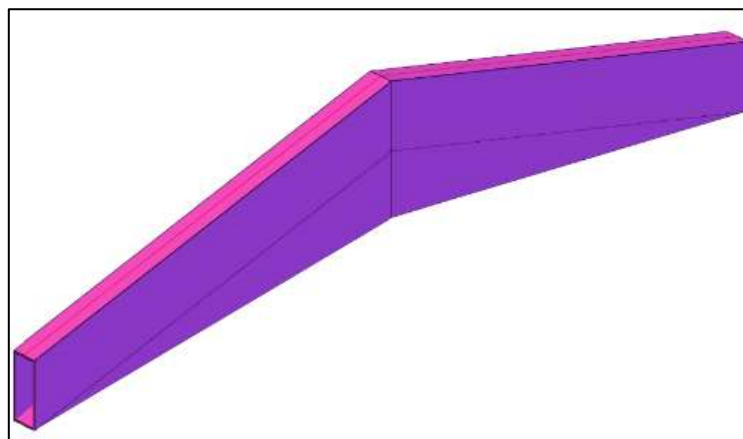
Conexión a momento Viga – Viga (Perfiles: tubulares)
